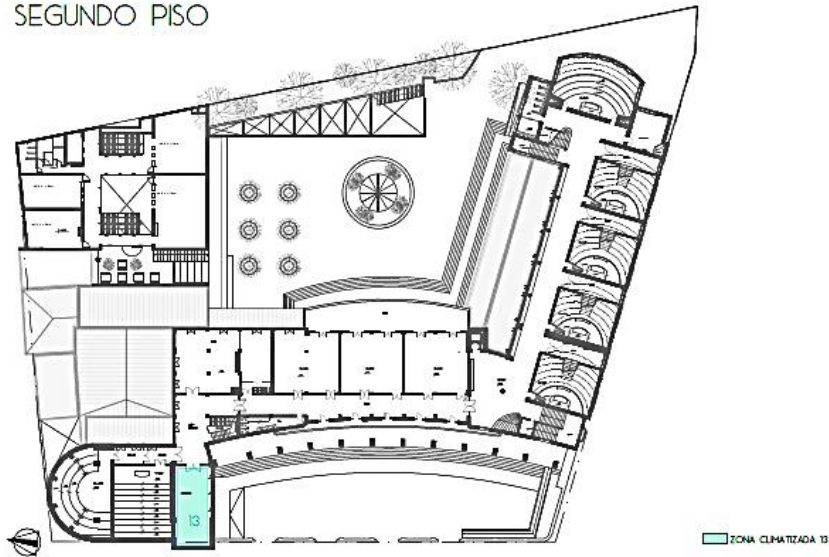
Planta esquema zonas climatizadas Segundo Piso.
